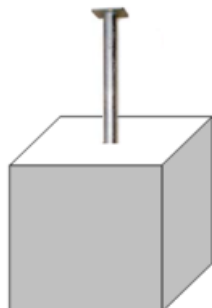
Estructura para el módulo fotovoltaico.
